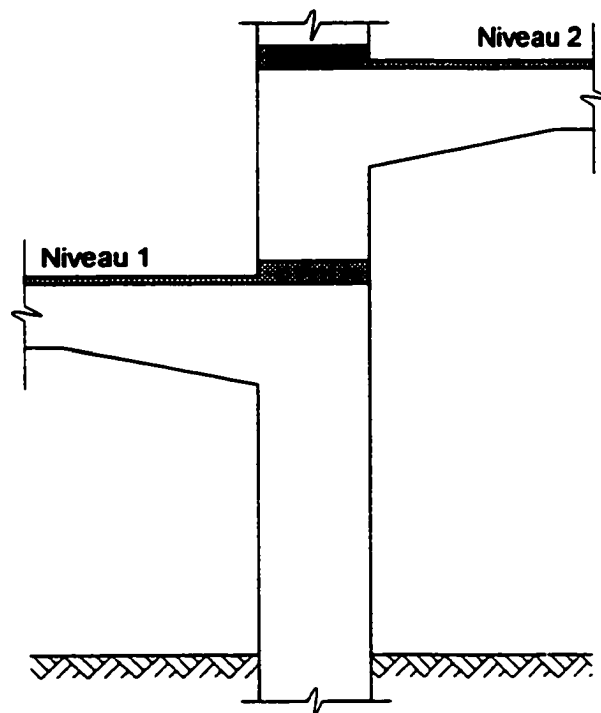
Profil typique des deux premiers niveaux du stationnement Webster
